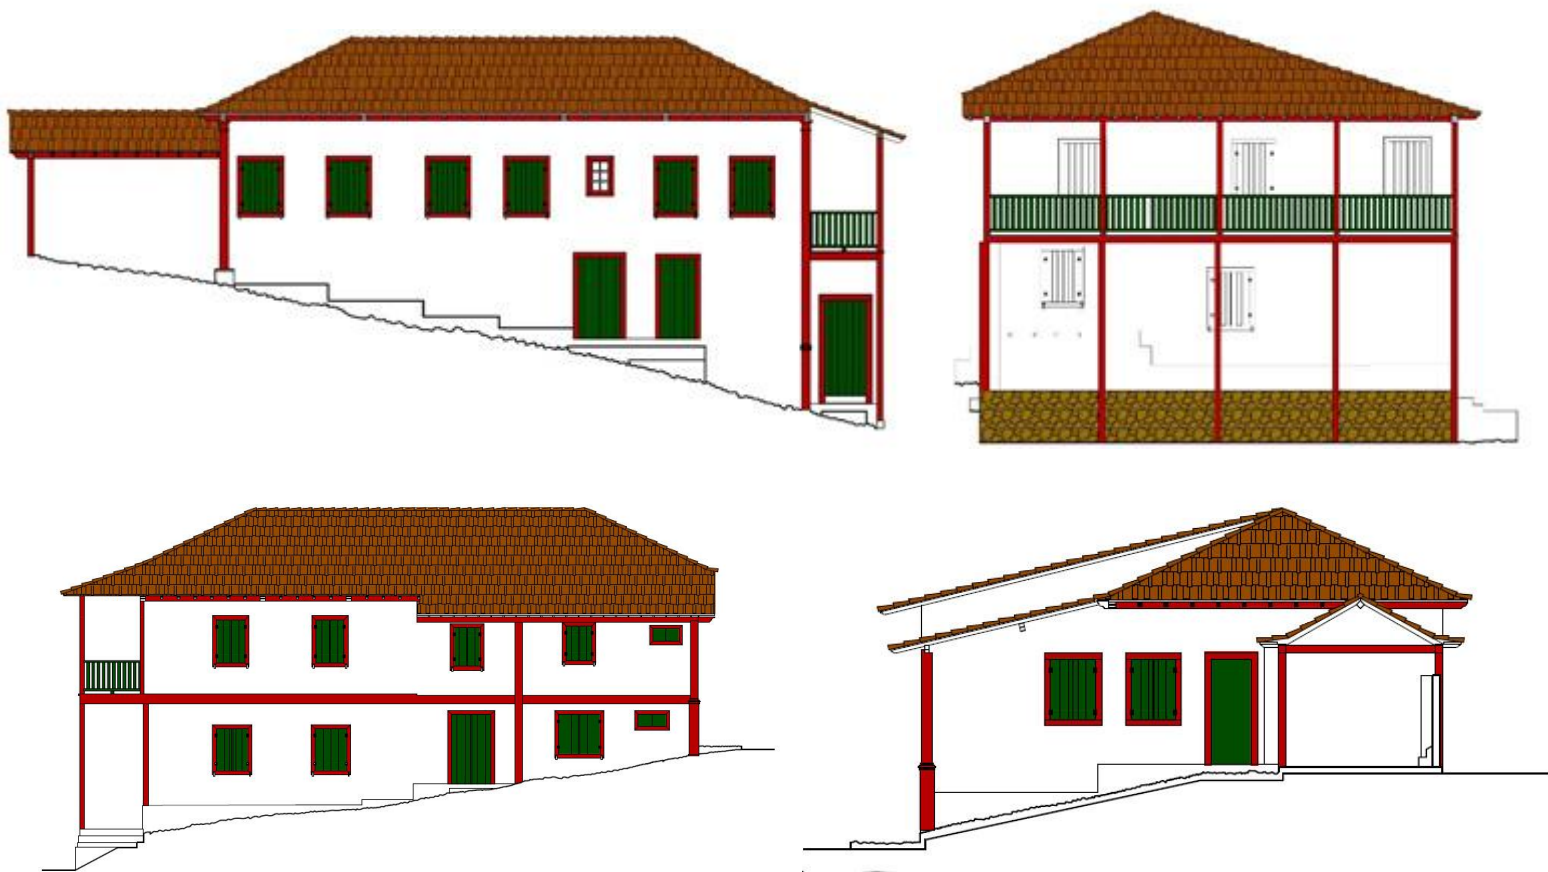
Fachadas actuales del Museo: arriba, fachada noroeste y suroeste; abajo, sureste y noreste
